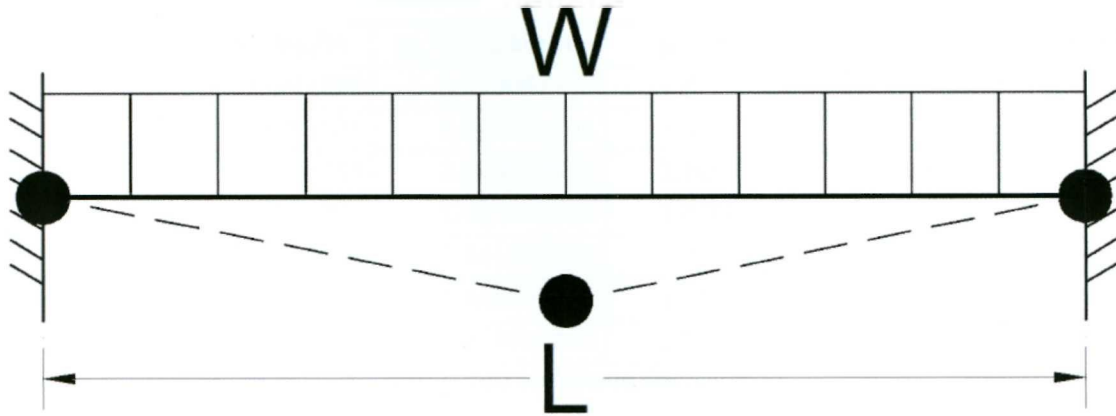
Viga doblemente empotrada, con mecanismo de colapso sobreimpuesto.¹¹⁴
